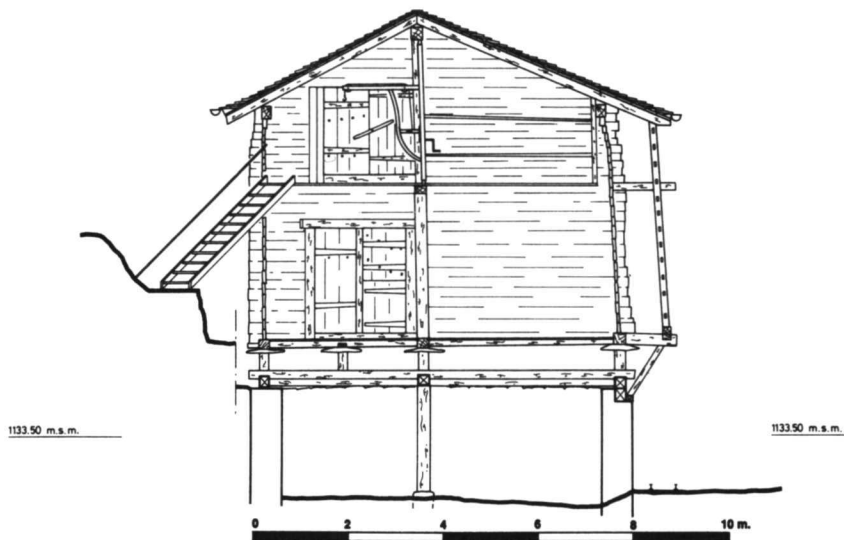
Le raccard : façade sud et coupe du rez-de-chaussée (Archéotech 112/9).
